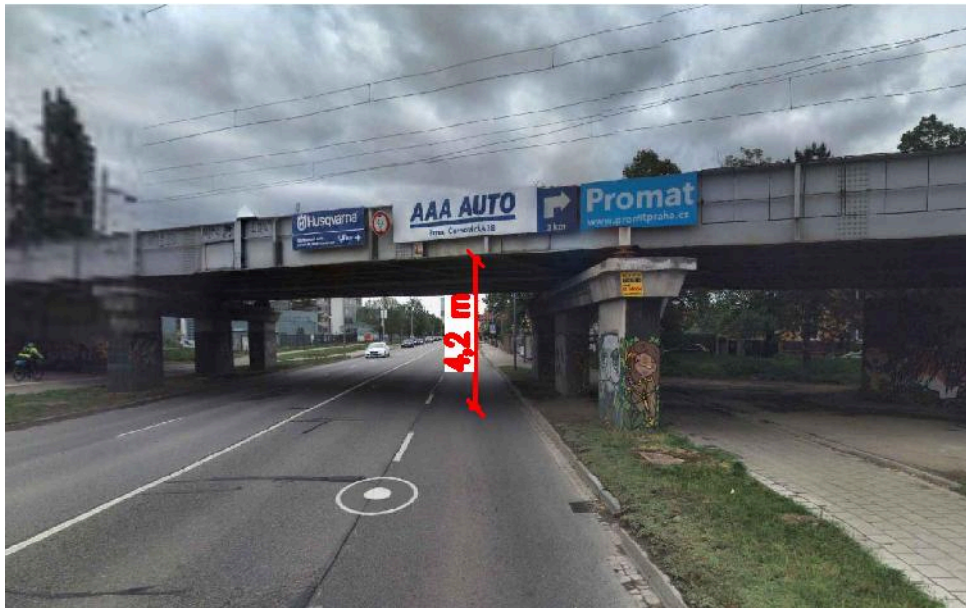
zájmový bod B; zdroj [2] upraveno
